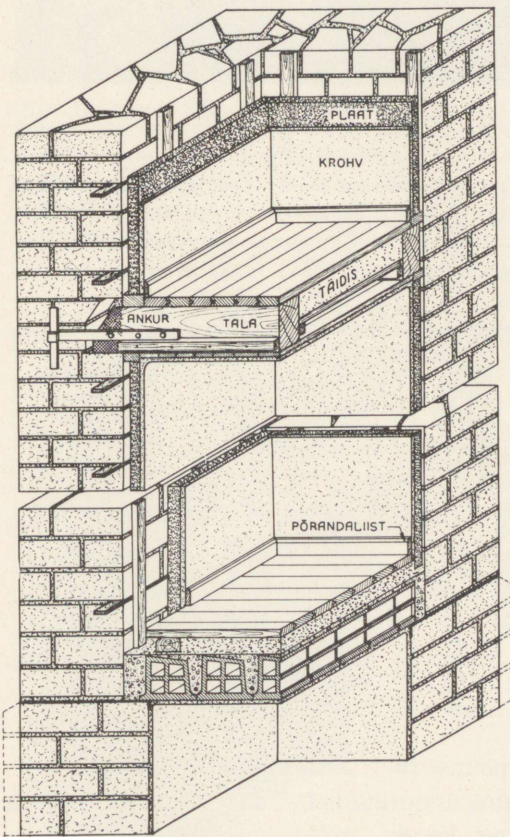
Обшивка плитняковой стены изоляционными плитами. Воздушный промежуток закрывается под и над перекрытием противопожарной перемычкой, для чего годится 5 см планка на растворе.
